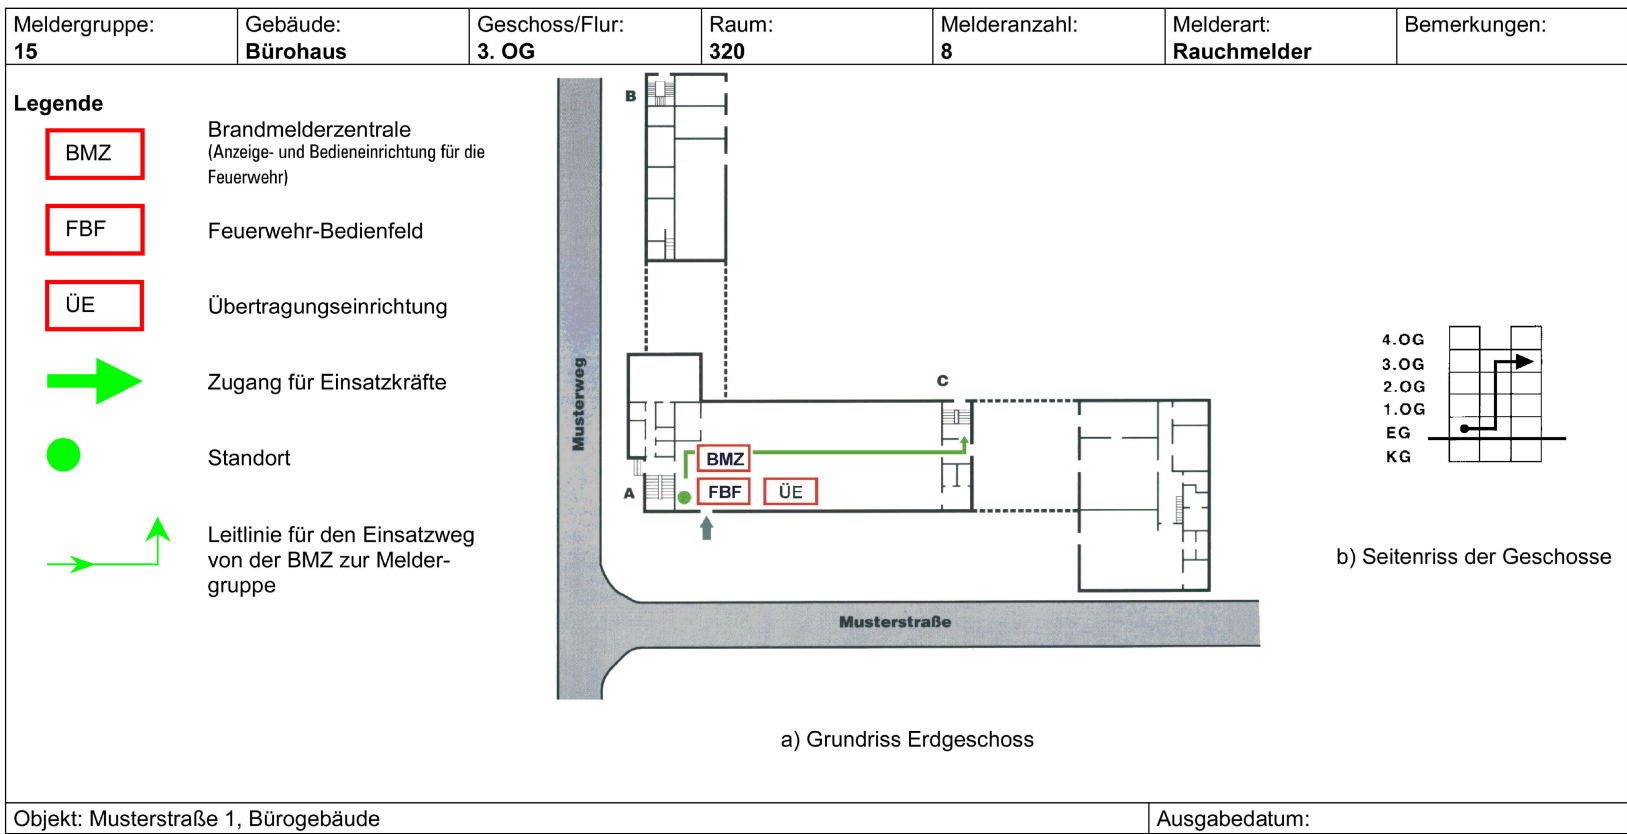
Darstellung einer Feuerwehr-Laufkarte: Vorderseite der Gebäudeübersicht als Grundriss EG, mit Seitenriss der Geschosse und Legende
